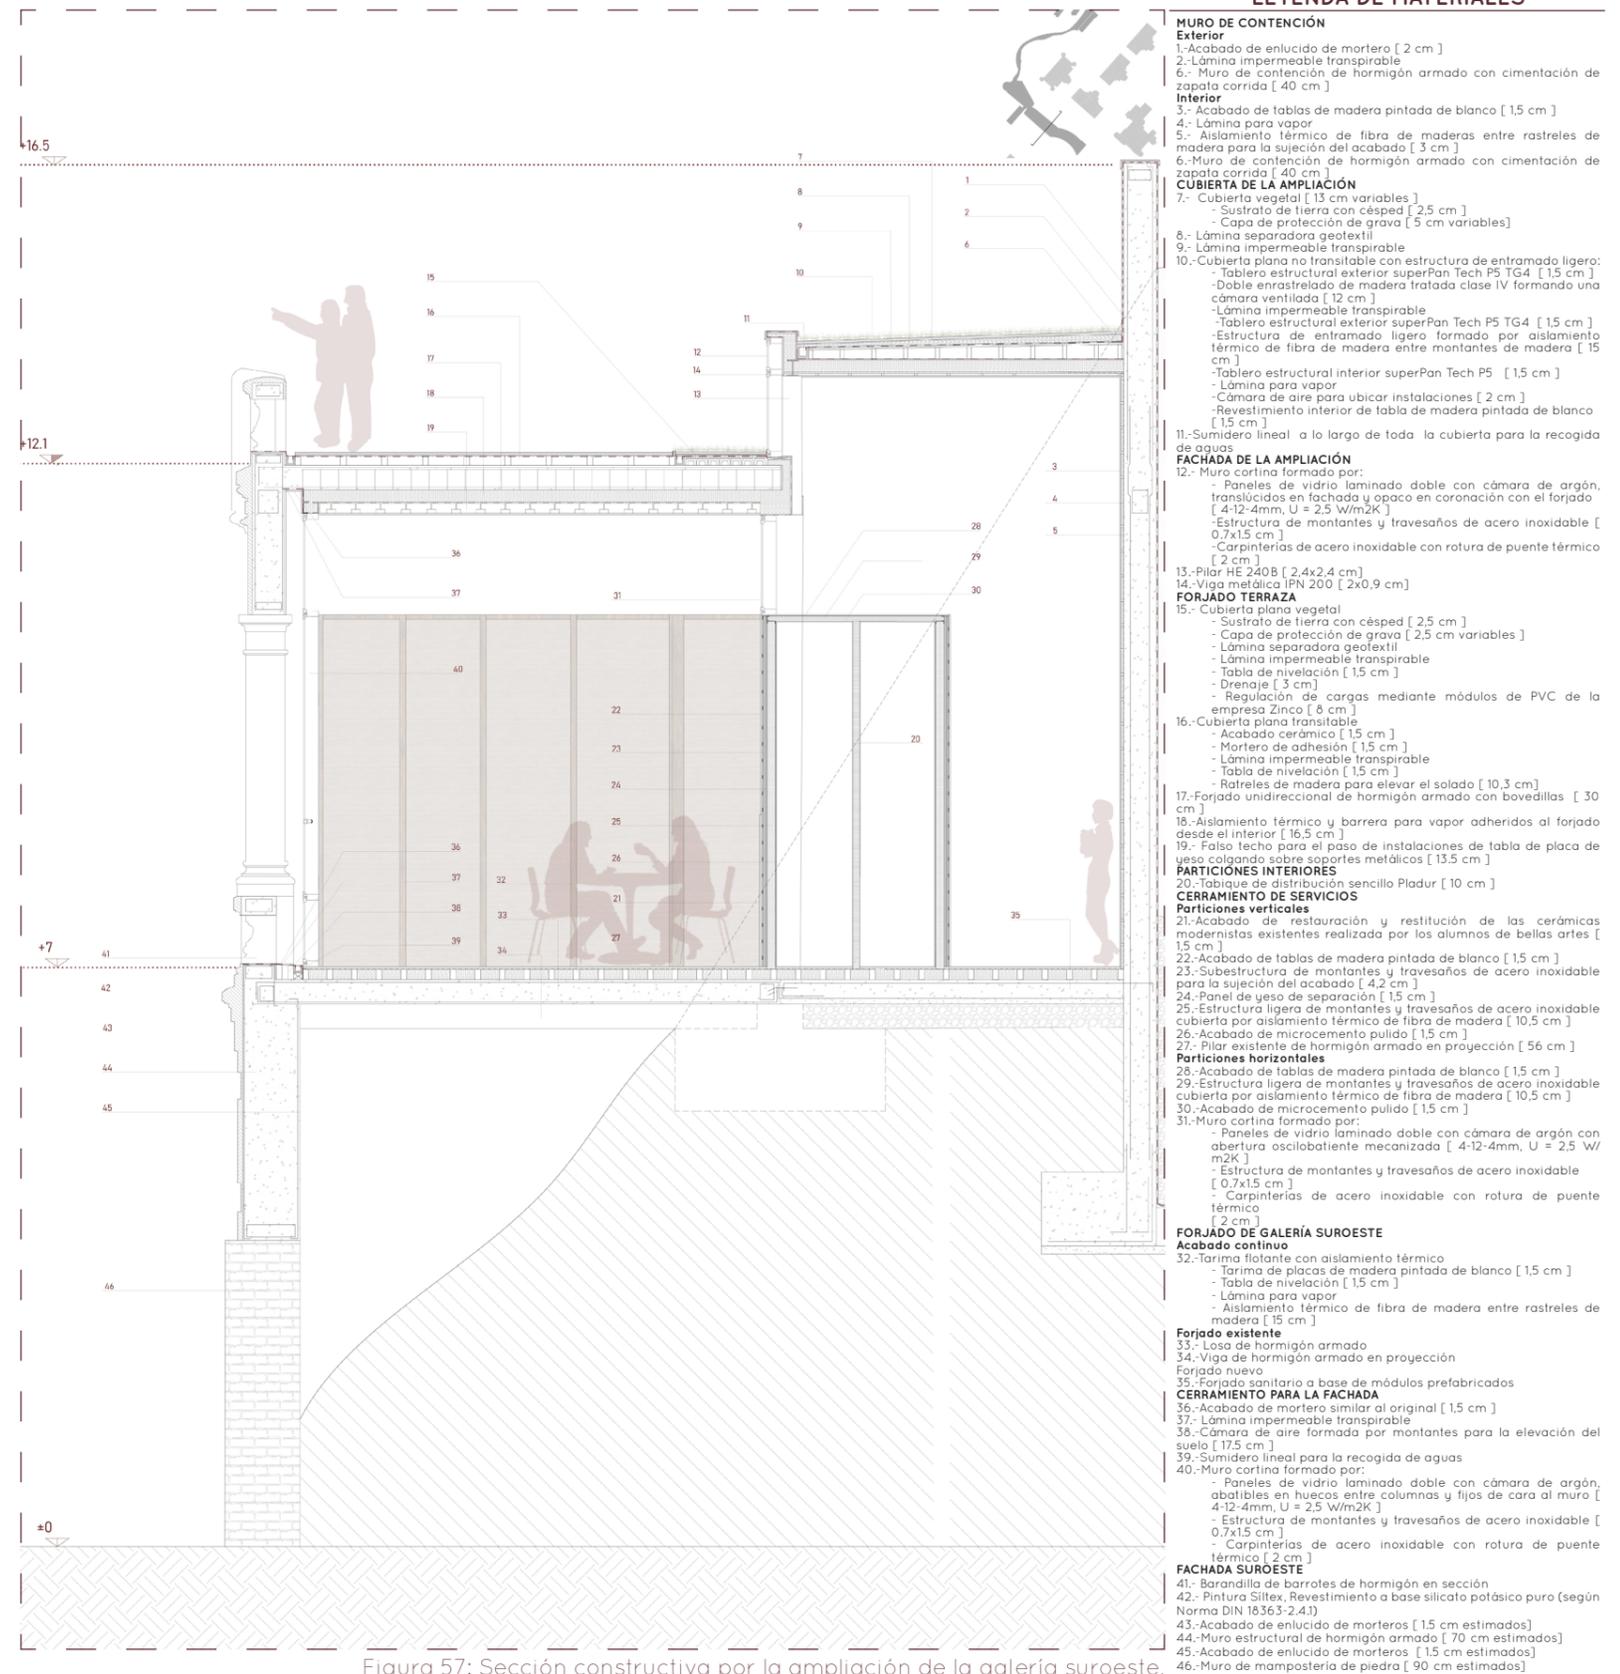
Sección constructiva por la ampliación de la galería suroeste.
